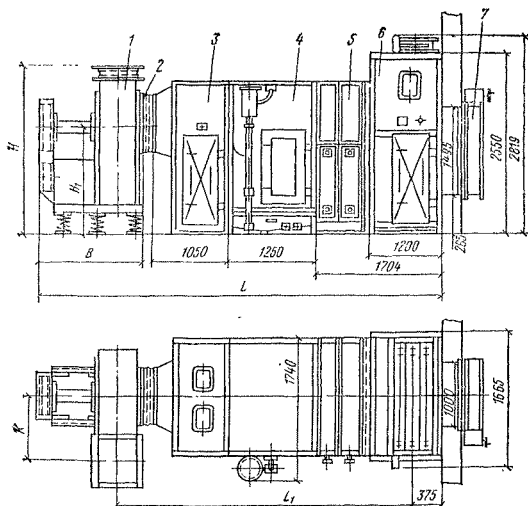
Приточная вентиляционная камера ИПК-25
